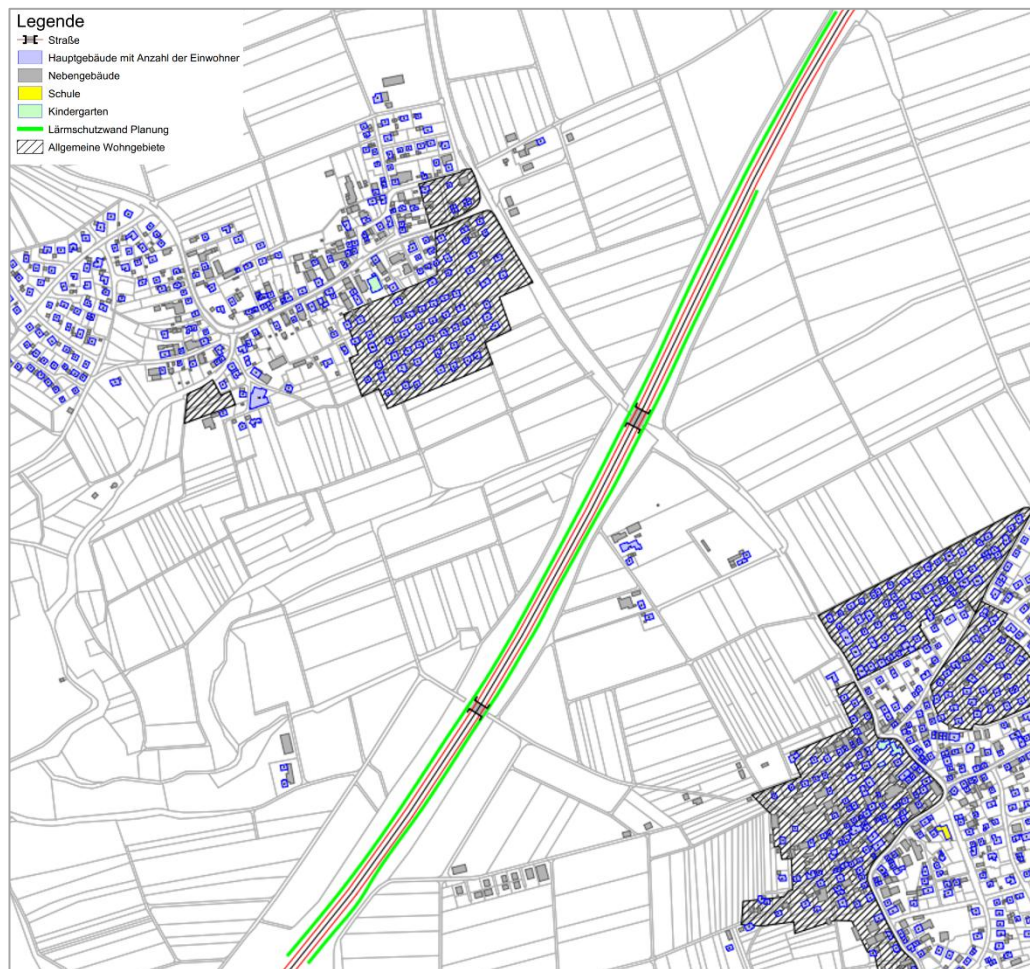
Lageplan der beidseitigen Lärmschutzwand entlang der A 81 Eutingen inkl. Kennzeichnung Wohngebiete (FNP)
